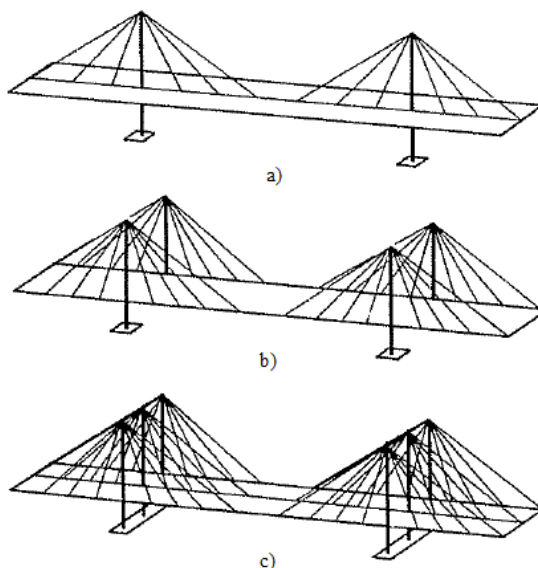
Sistema de um plano de suspensão a); dois planos de suspensão b); três planos de suspensão c) (Walther 1999)
